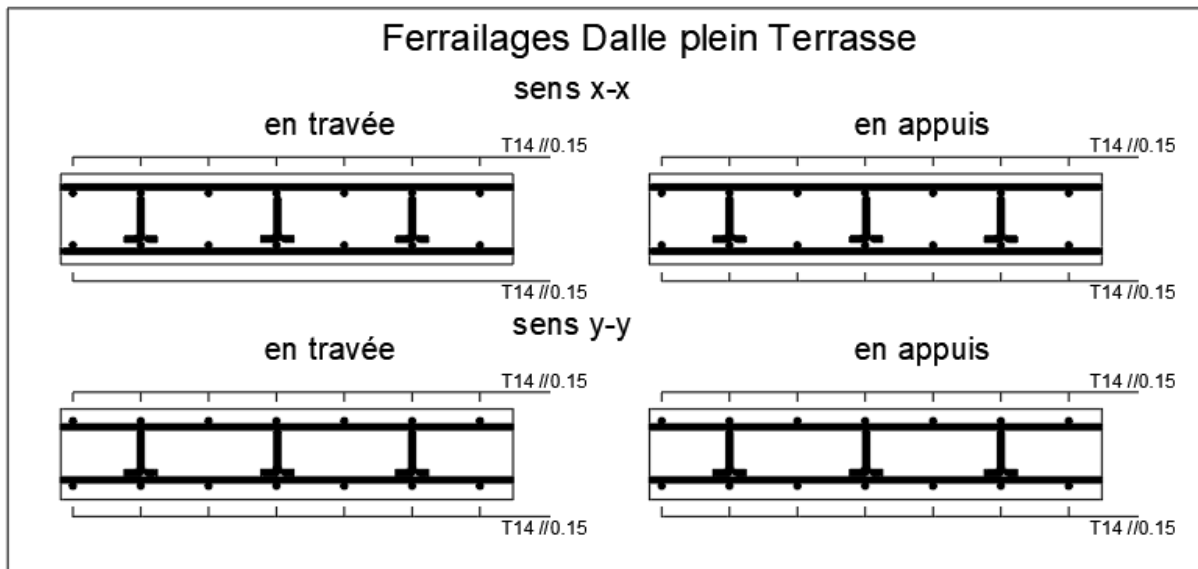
Schéma de Ferrailages Dalle plein terrasse.
